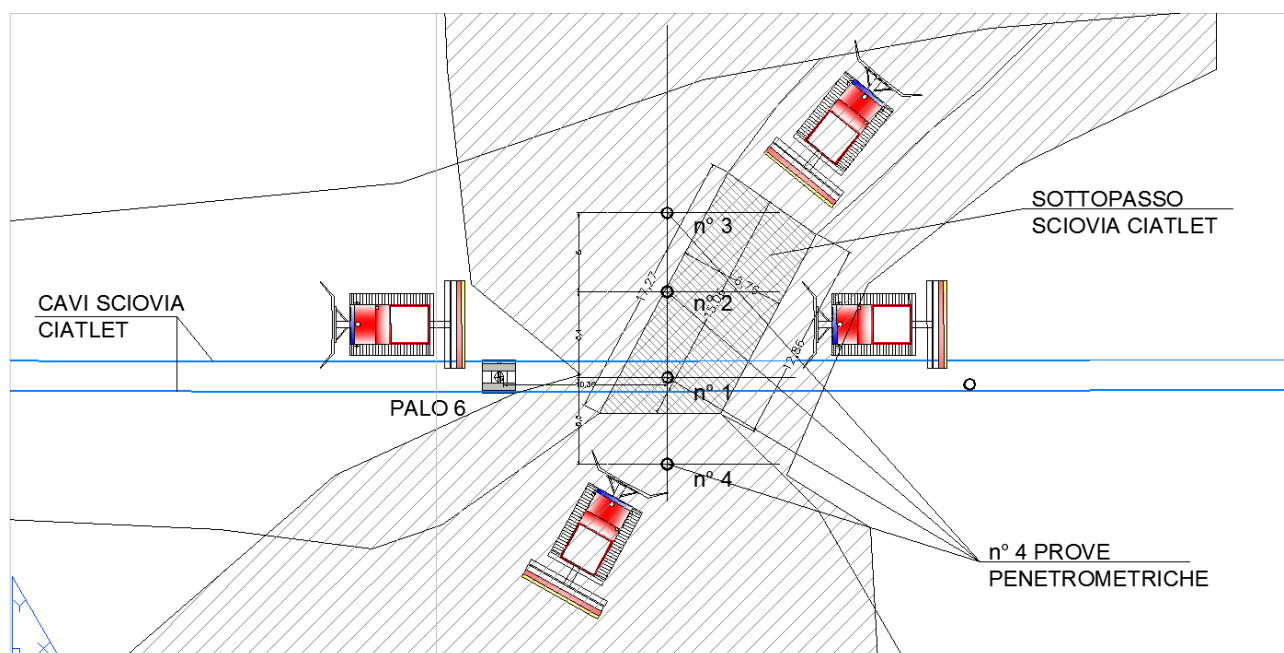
/2 – Ubicazione delle indagini su rilievo planimetrico
